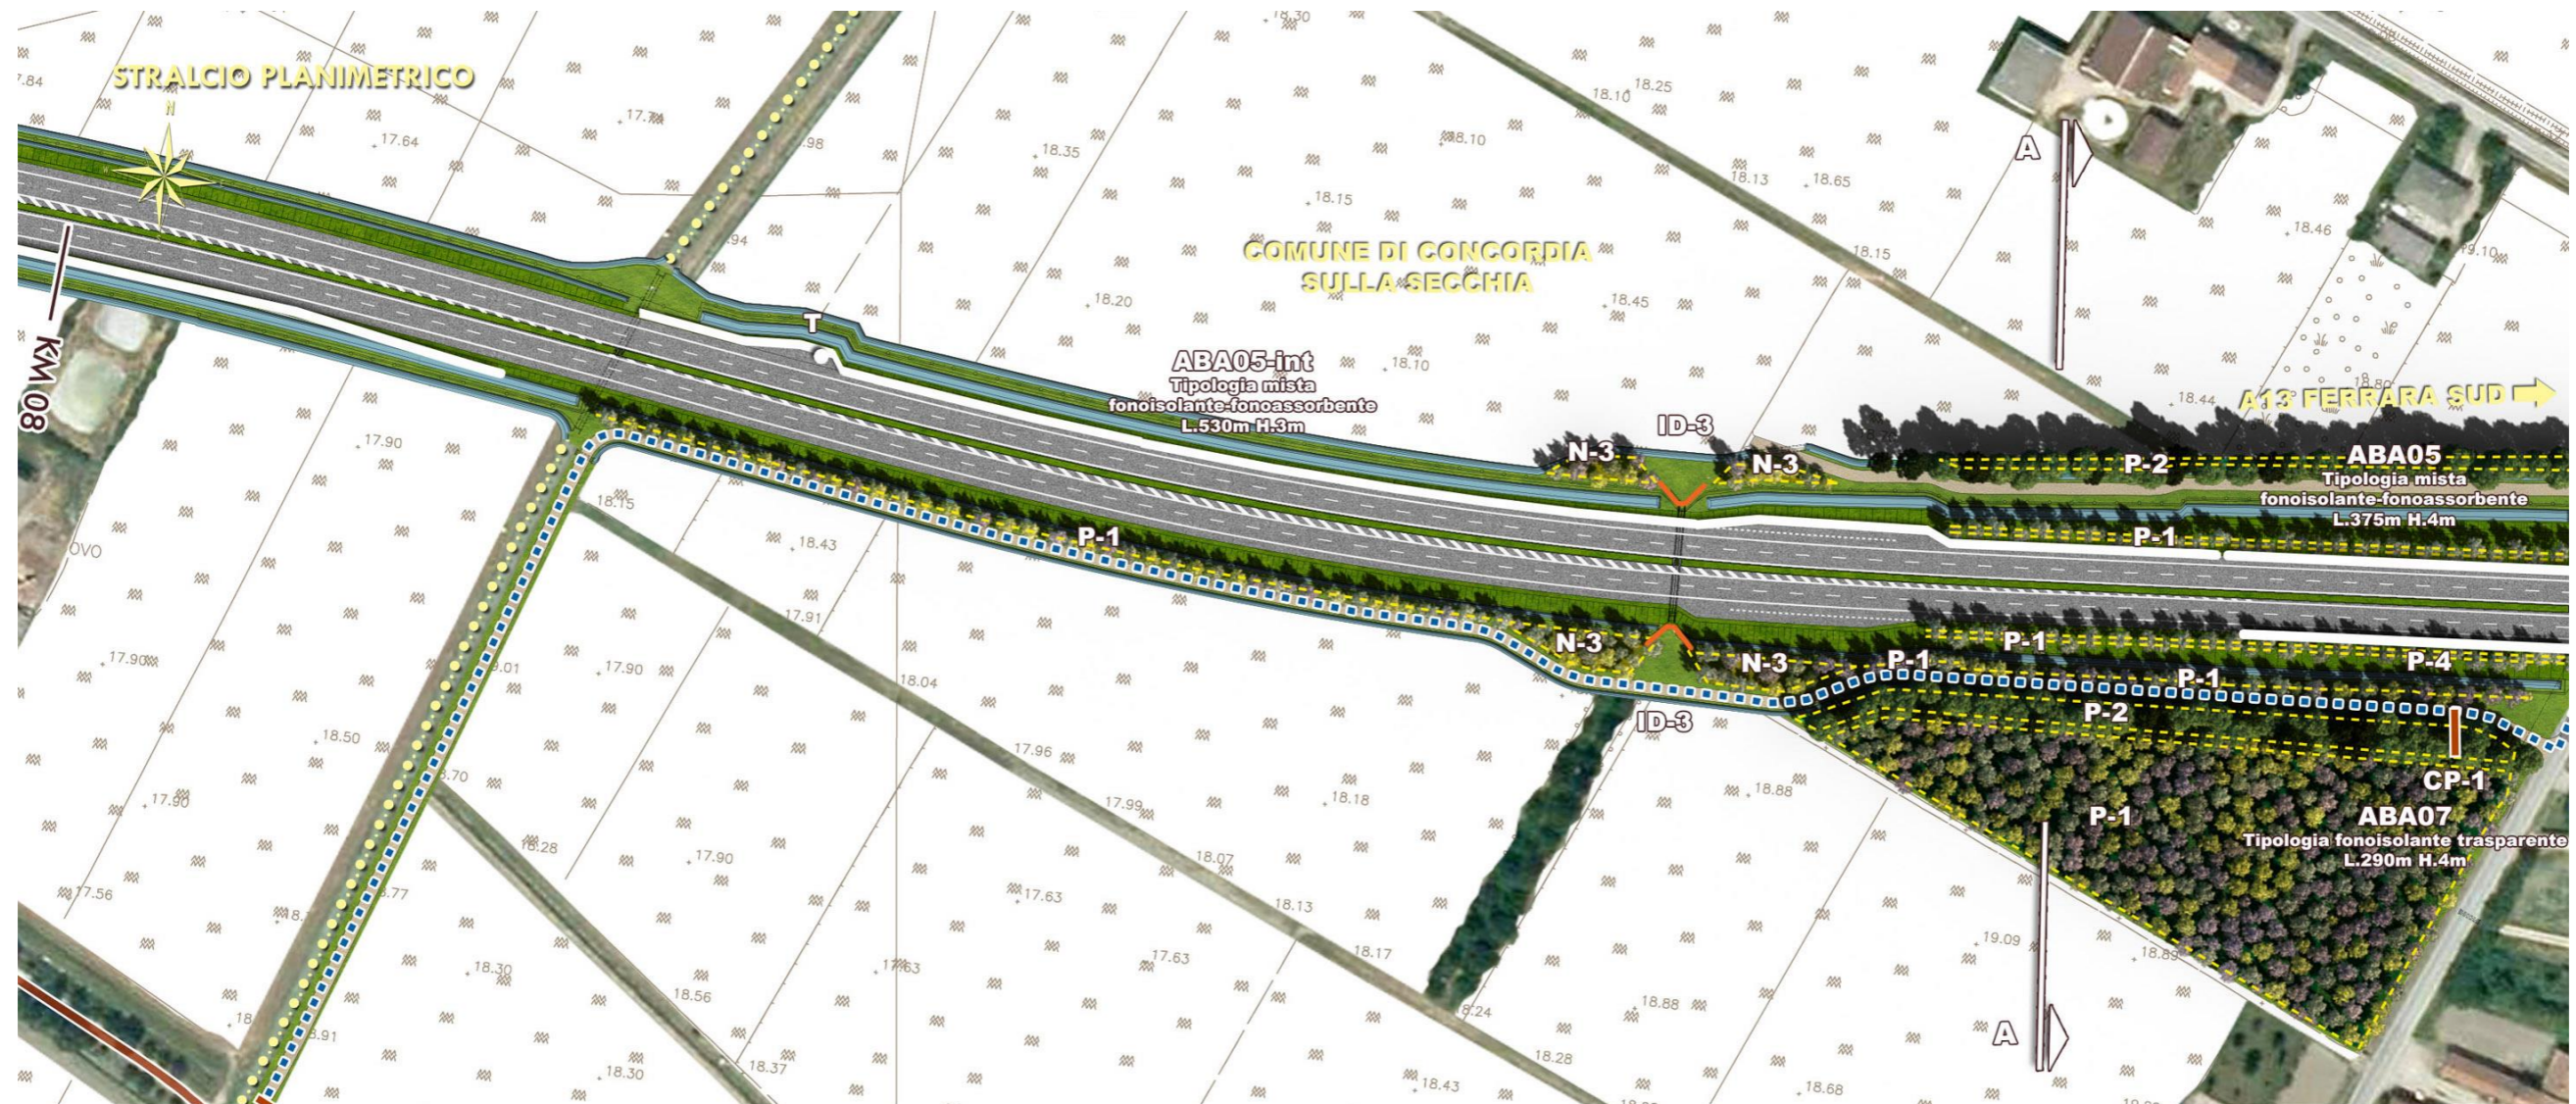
STRALCIO PLANIMETRICO CON INDIVIDUAZIONE DELLE PROTEZIONI ANTIFONICHE E SEZIONI TERRITORIALE
